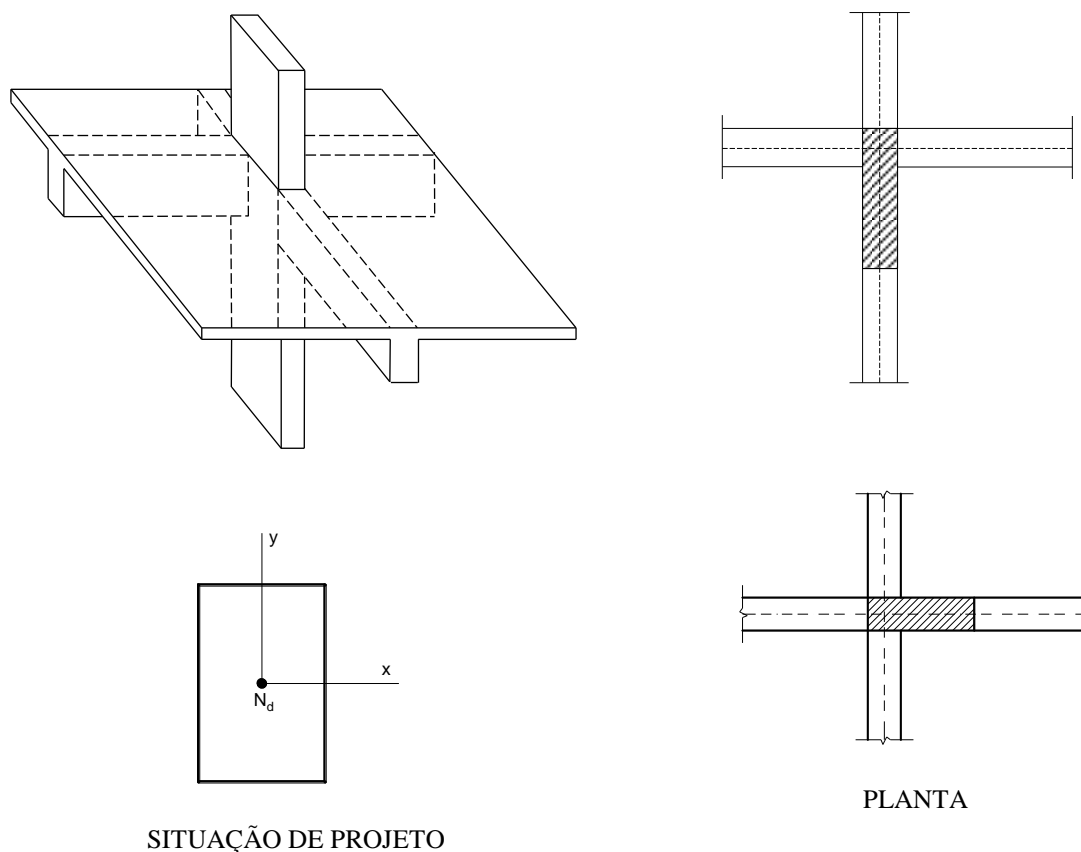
Arranjo estrutural e situação de projeto de pilar intermediário.
